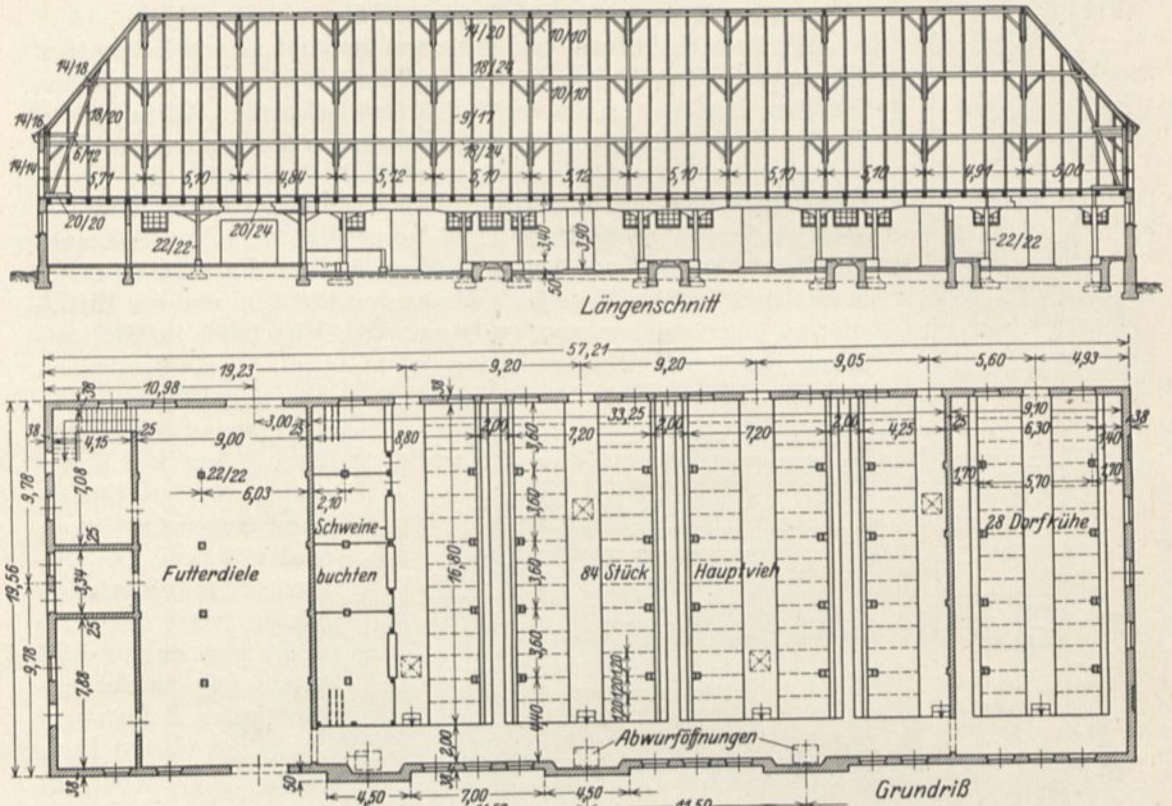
Viehhaus in Groß-Kussewitz (Mecklenburg). Grundriß und Längenschnitt.
